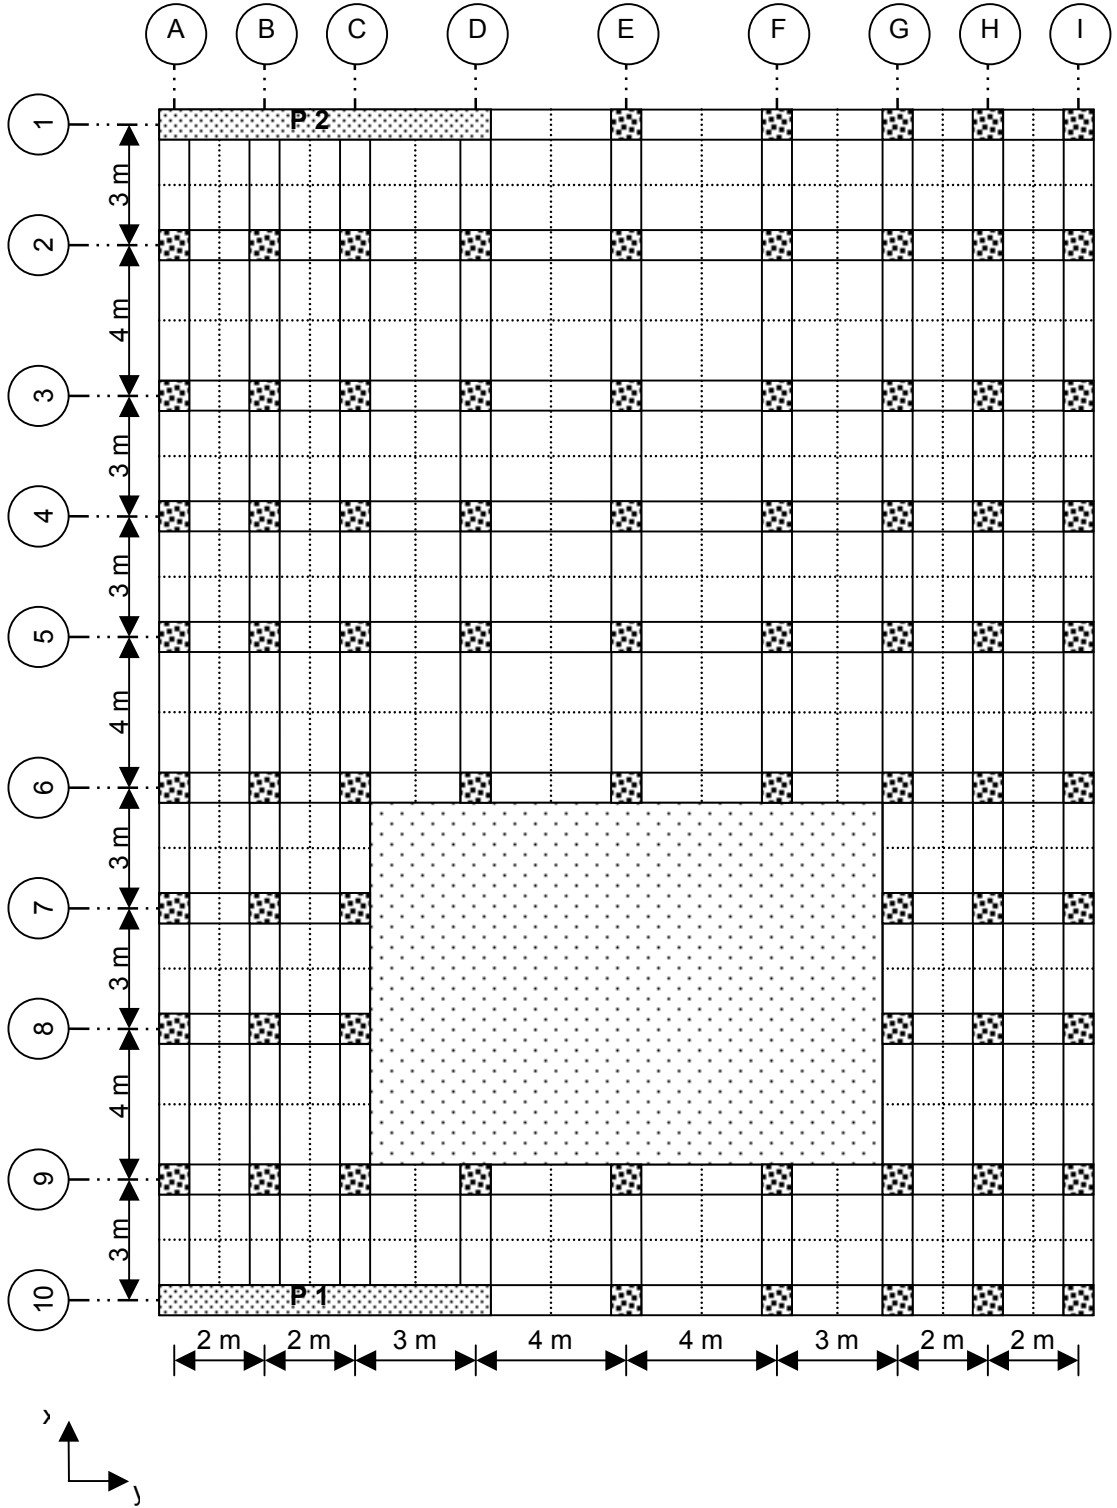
Örnek 5.10'in kat kalıp planı
